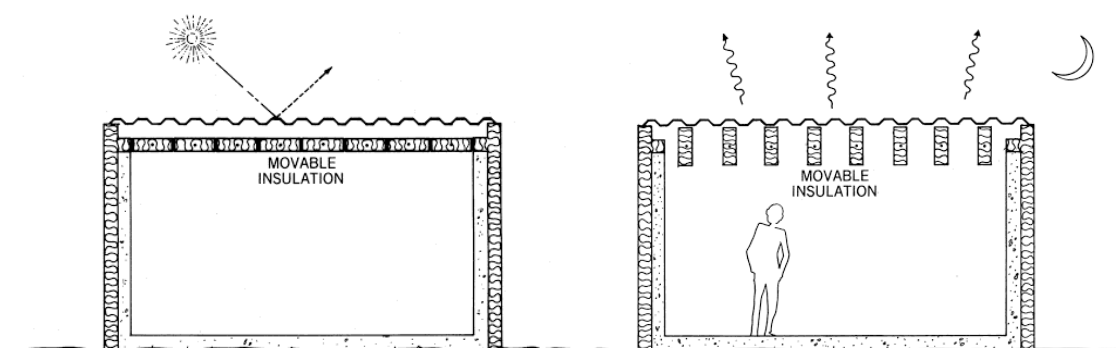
Cubierta metálica con aislante móvil. Fuente: Lechner (2014).
